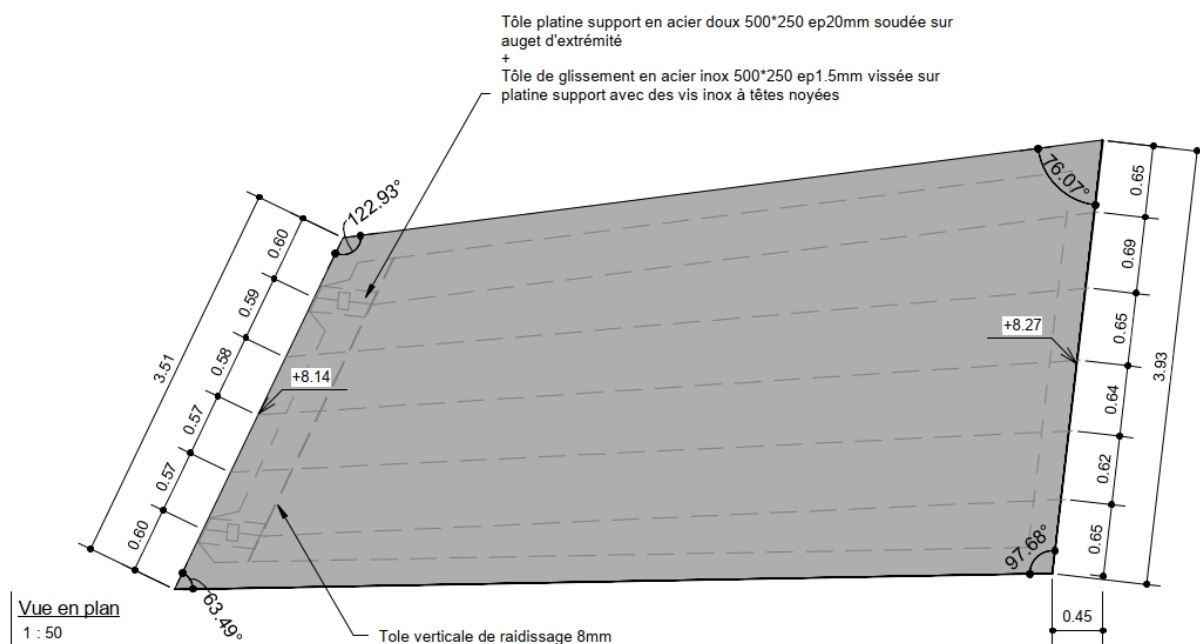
Vue en plan du platelage de type 5 (platelage d'extrémité rive gauche)
